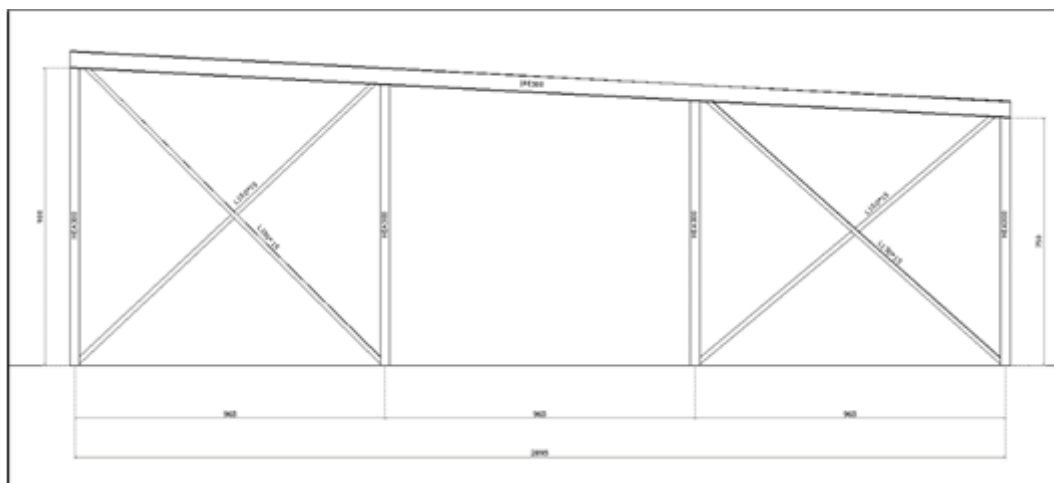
Prospetto struttura pensilina di copertura della baia di carico
